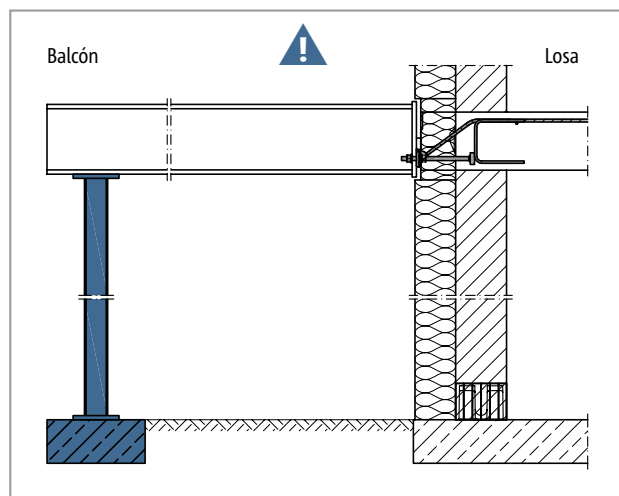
Schöck Isokorb® XT tipo SQ: Se requiere apuntalamiento continuo
